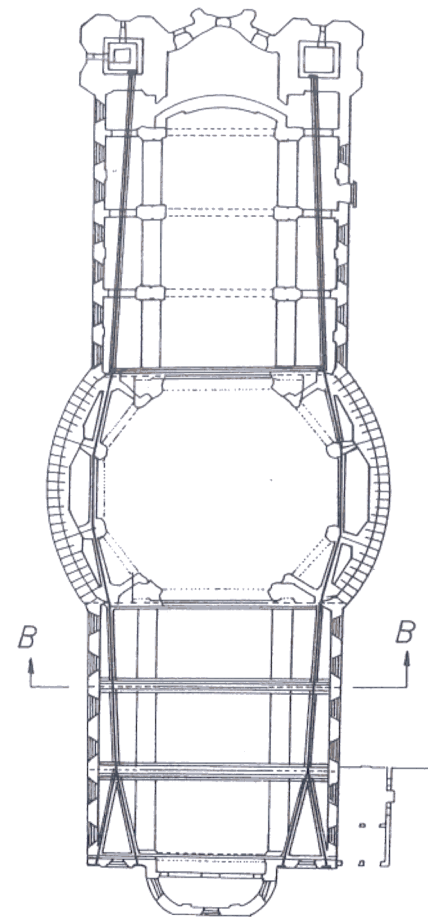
La cathédrale de Saint-Gall. Plan donnant le schéma de la consolidation statique, avec l'indication des câbles longitudinaux.
